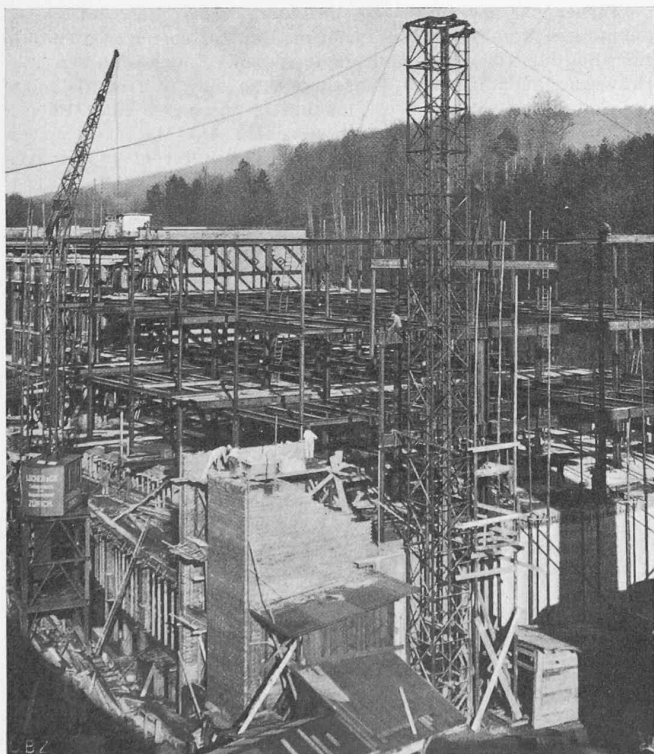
Neubau aus Süden: Stahlskelett auf Eisenbeton-Unterbau.
